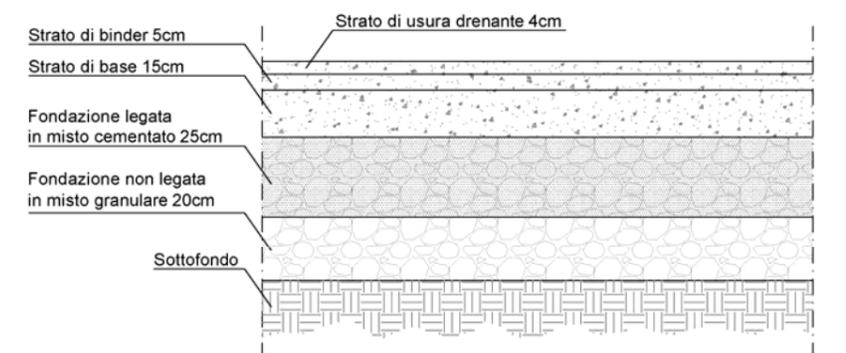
Nuove piazzole - PAVIMENTAZIONE TIPO 1
